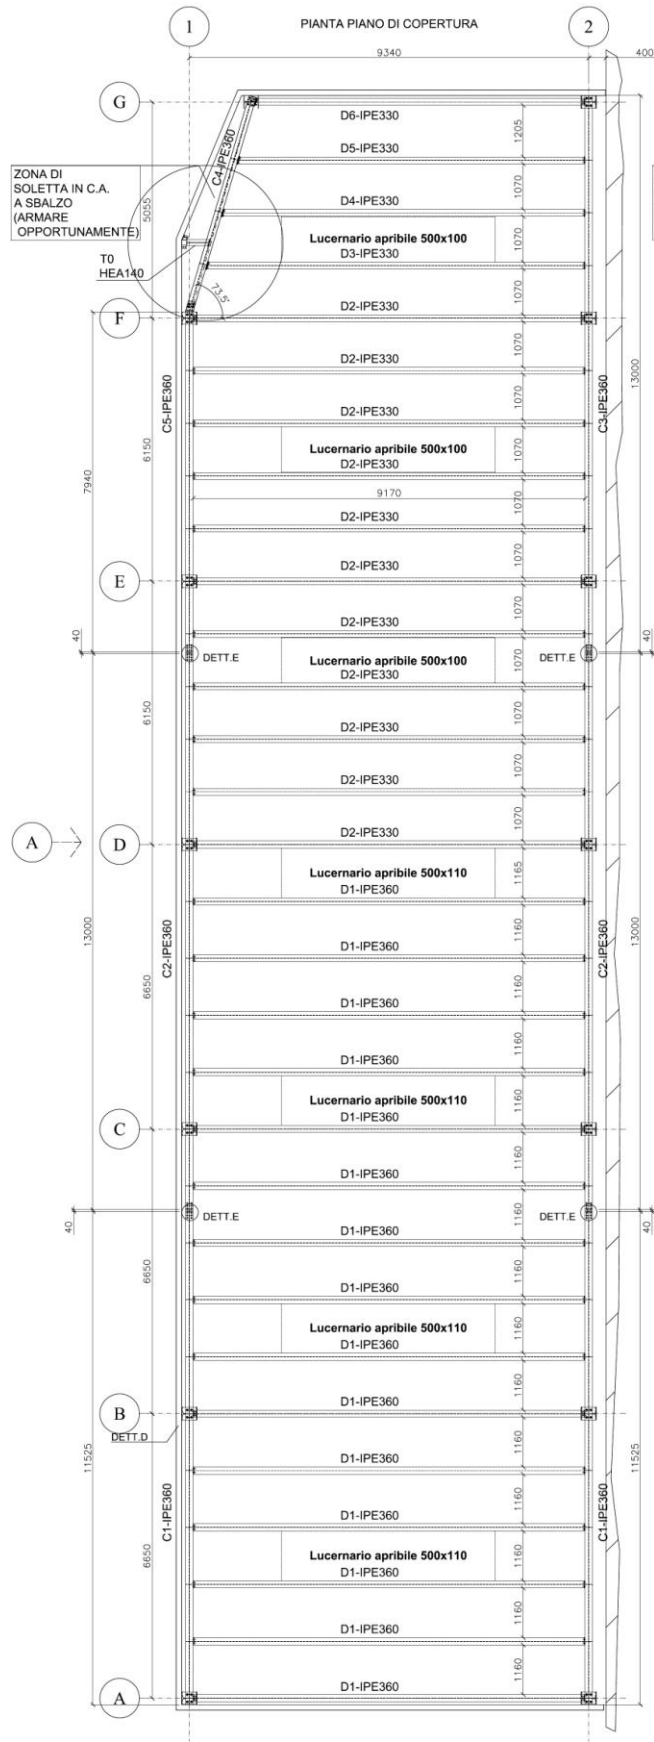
Particolare di A.2006.a.us.T03 - Piante - Pianta copertura
